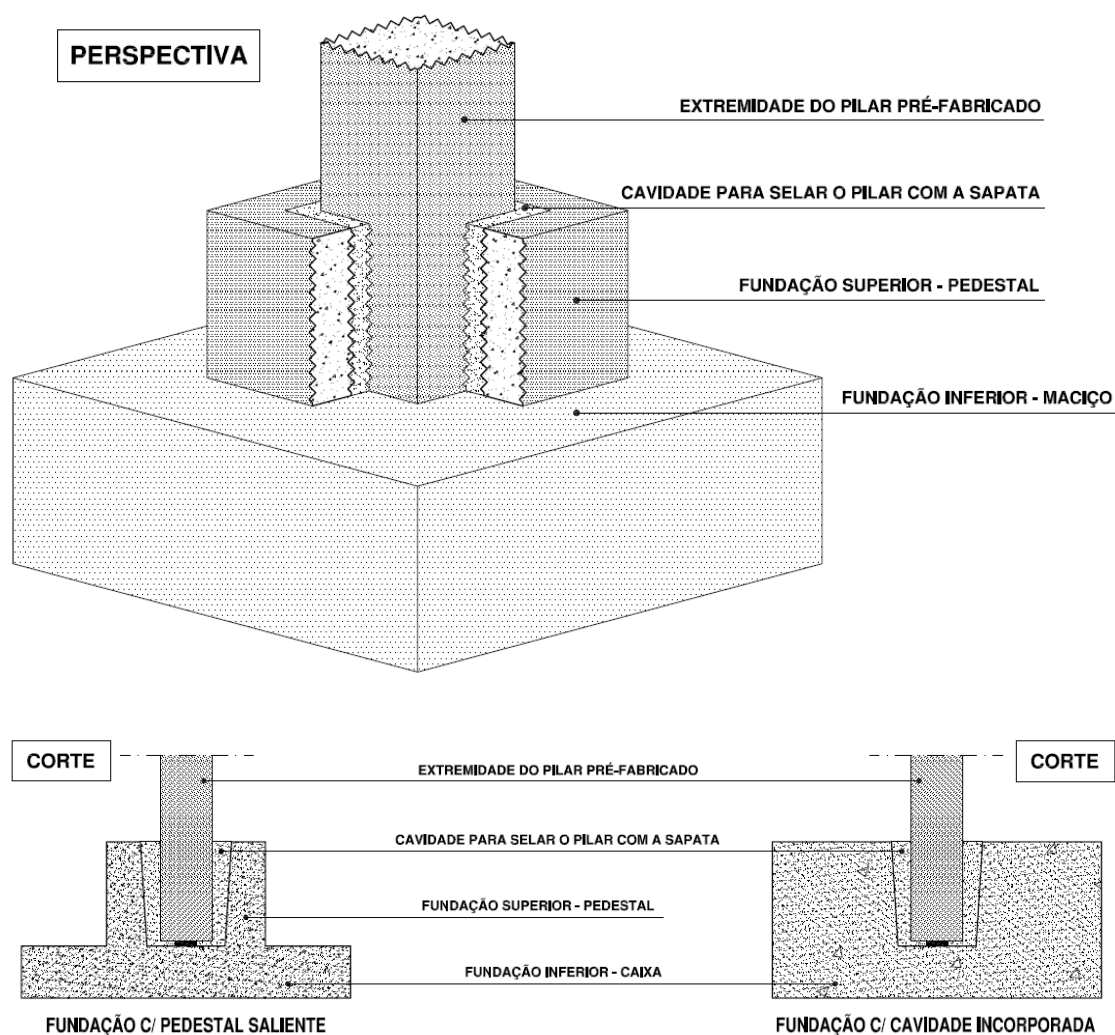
Ligação pilar – fundação através de cavidade (retirado de (REGUENGO, 2010))
